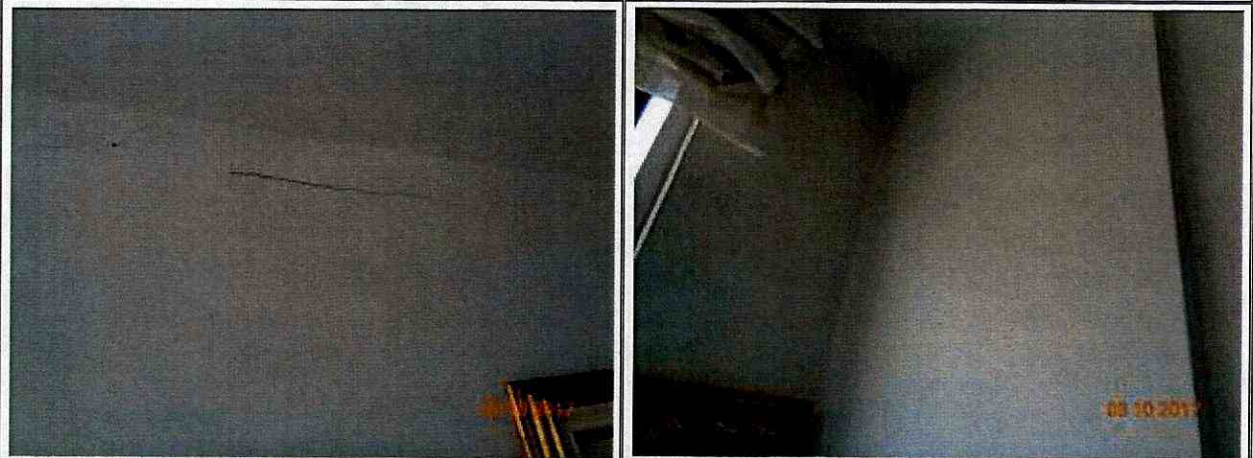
y 11. Grietas y fisuras en apartamentos visitados
